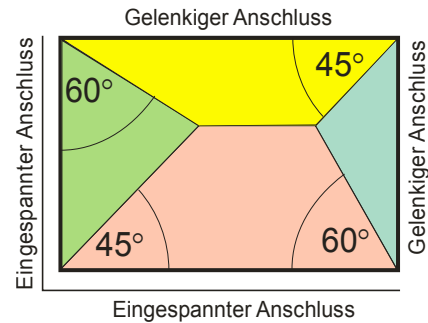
Ermittlung der Auflagerkräfte einer zweiachsig gespannten Deckenplatte
